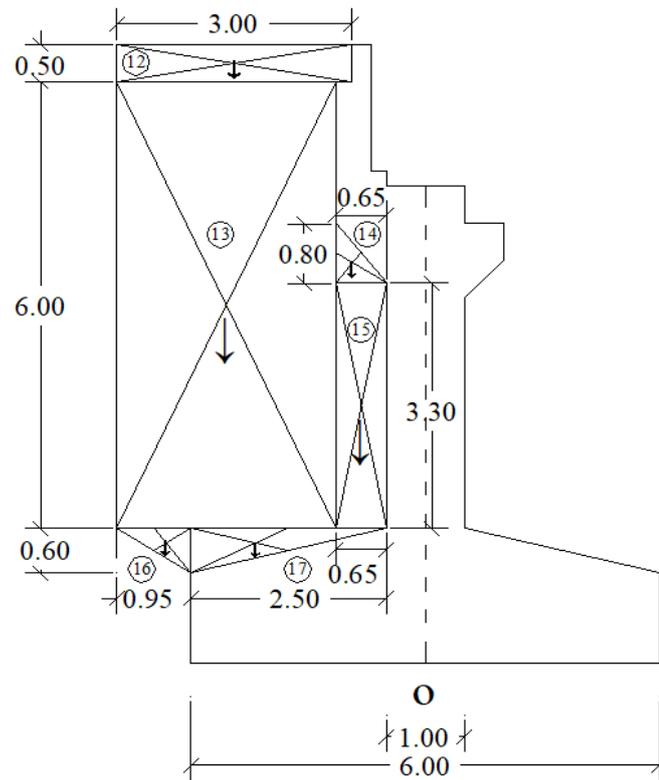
62 Pembebanan *abutment* akibat beban sendiri struktur atas
